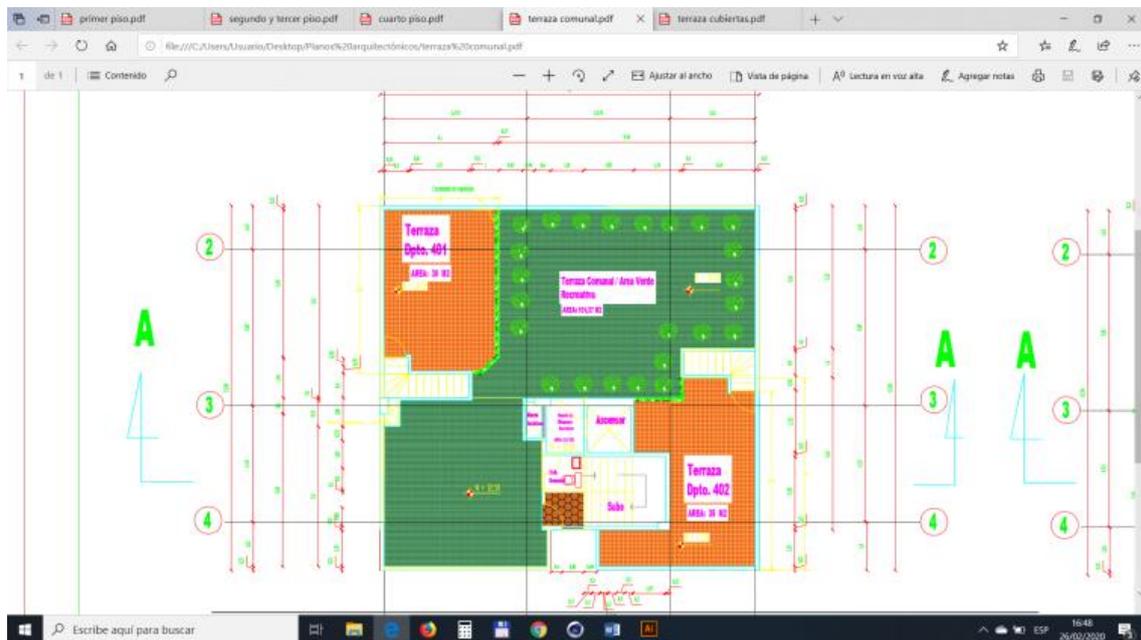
Pdf de los planos de la terraza comunal del edificio, 2020
